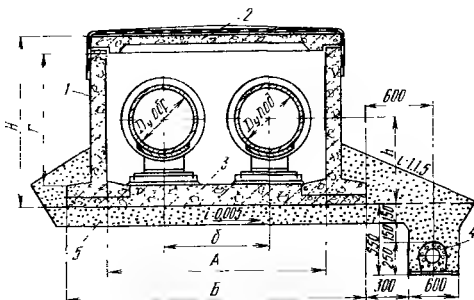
Канал из железобетонных тавровых стеновых блоков, ребристых плит перекрытия и плит днища с односторонним дренажем из керамзитобетонных трубофилт-
